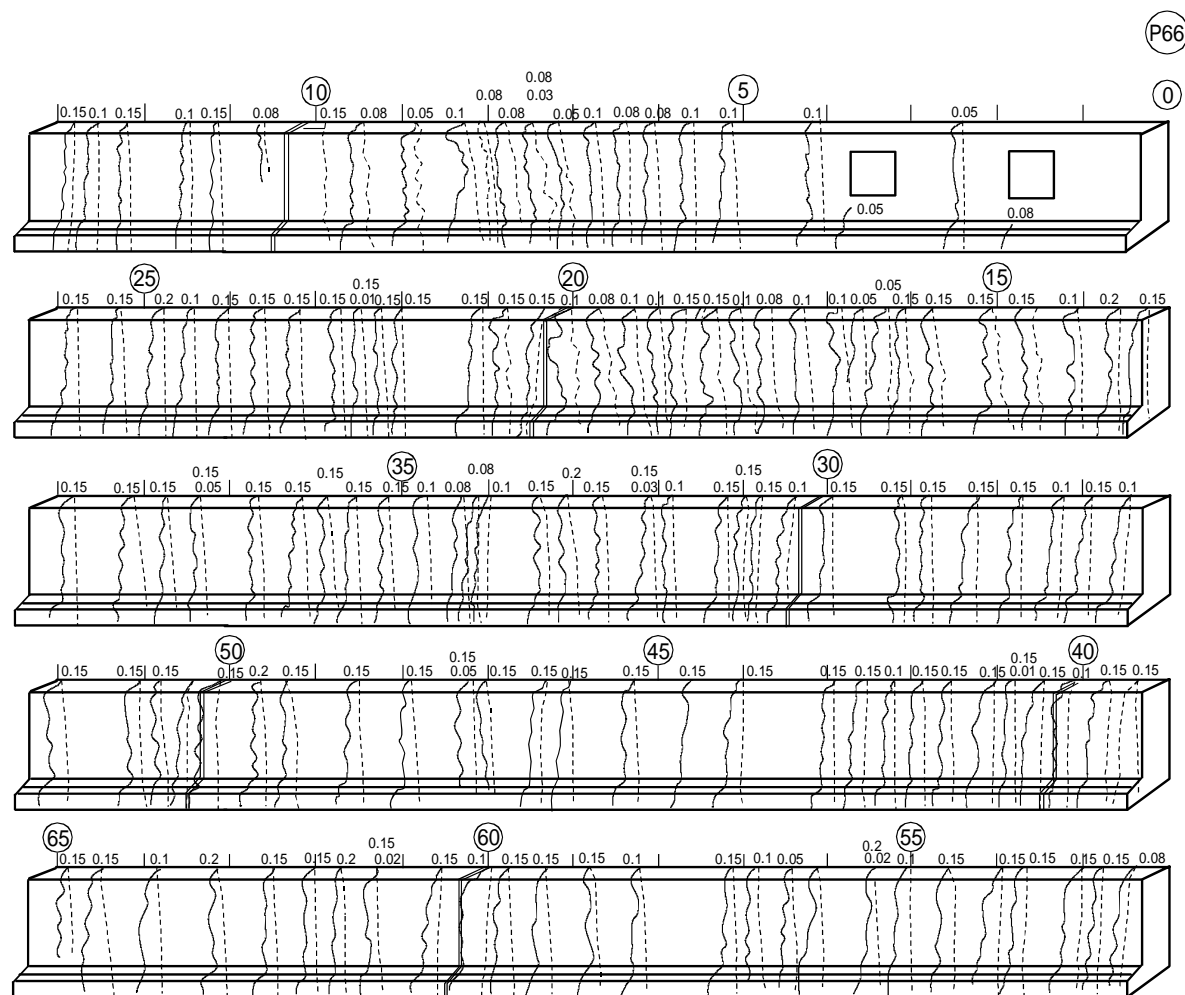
新淀川橋梁の高欄ひび割れ状況
